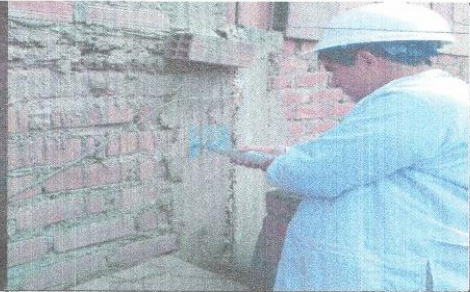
Realizando aplicación del esclerometro en la cara de la columna de la vivienda familiar.
